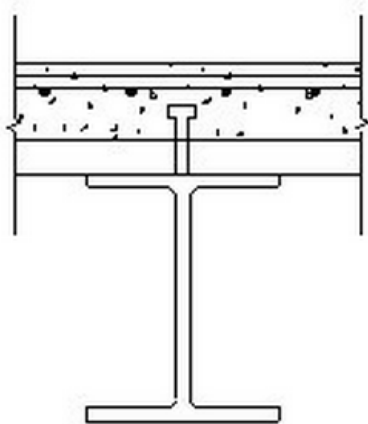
Secção mista com viga metálica e laje em betão armado. [93]
